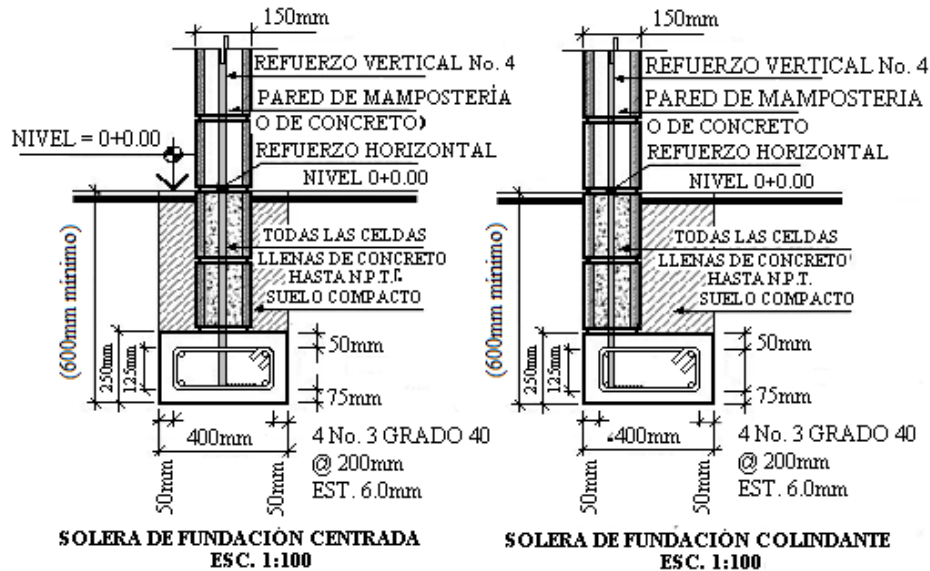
Requisito mínimo para solera de fundación en vivienda de dos plantas
